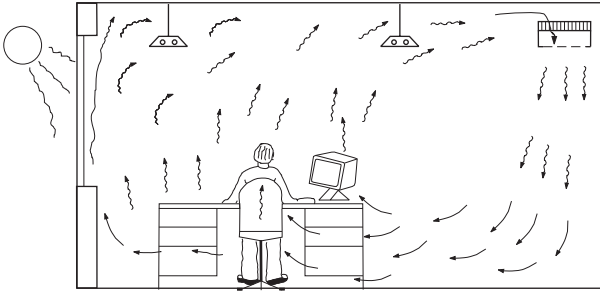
Convecteur de refroidissement de plafond contre ou à proximité d'un mur de couloir
